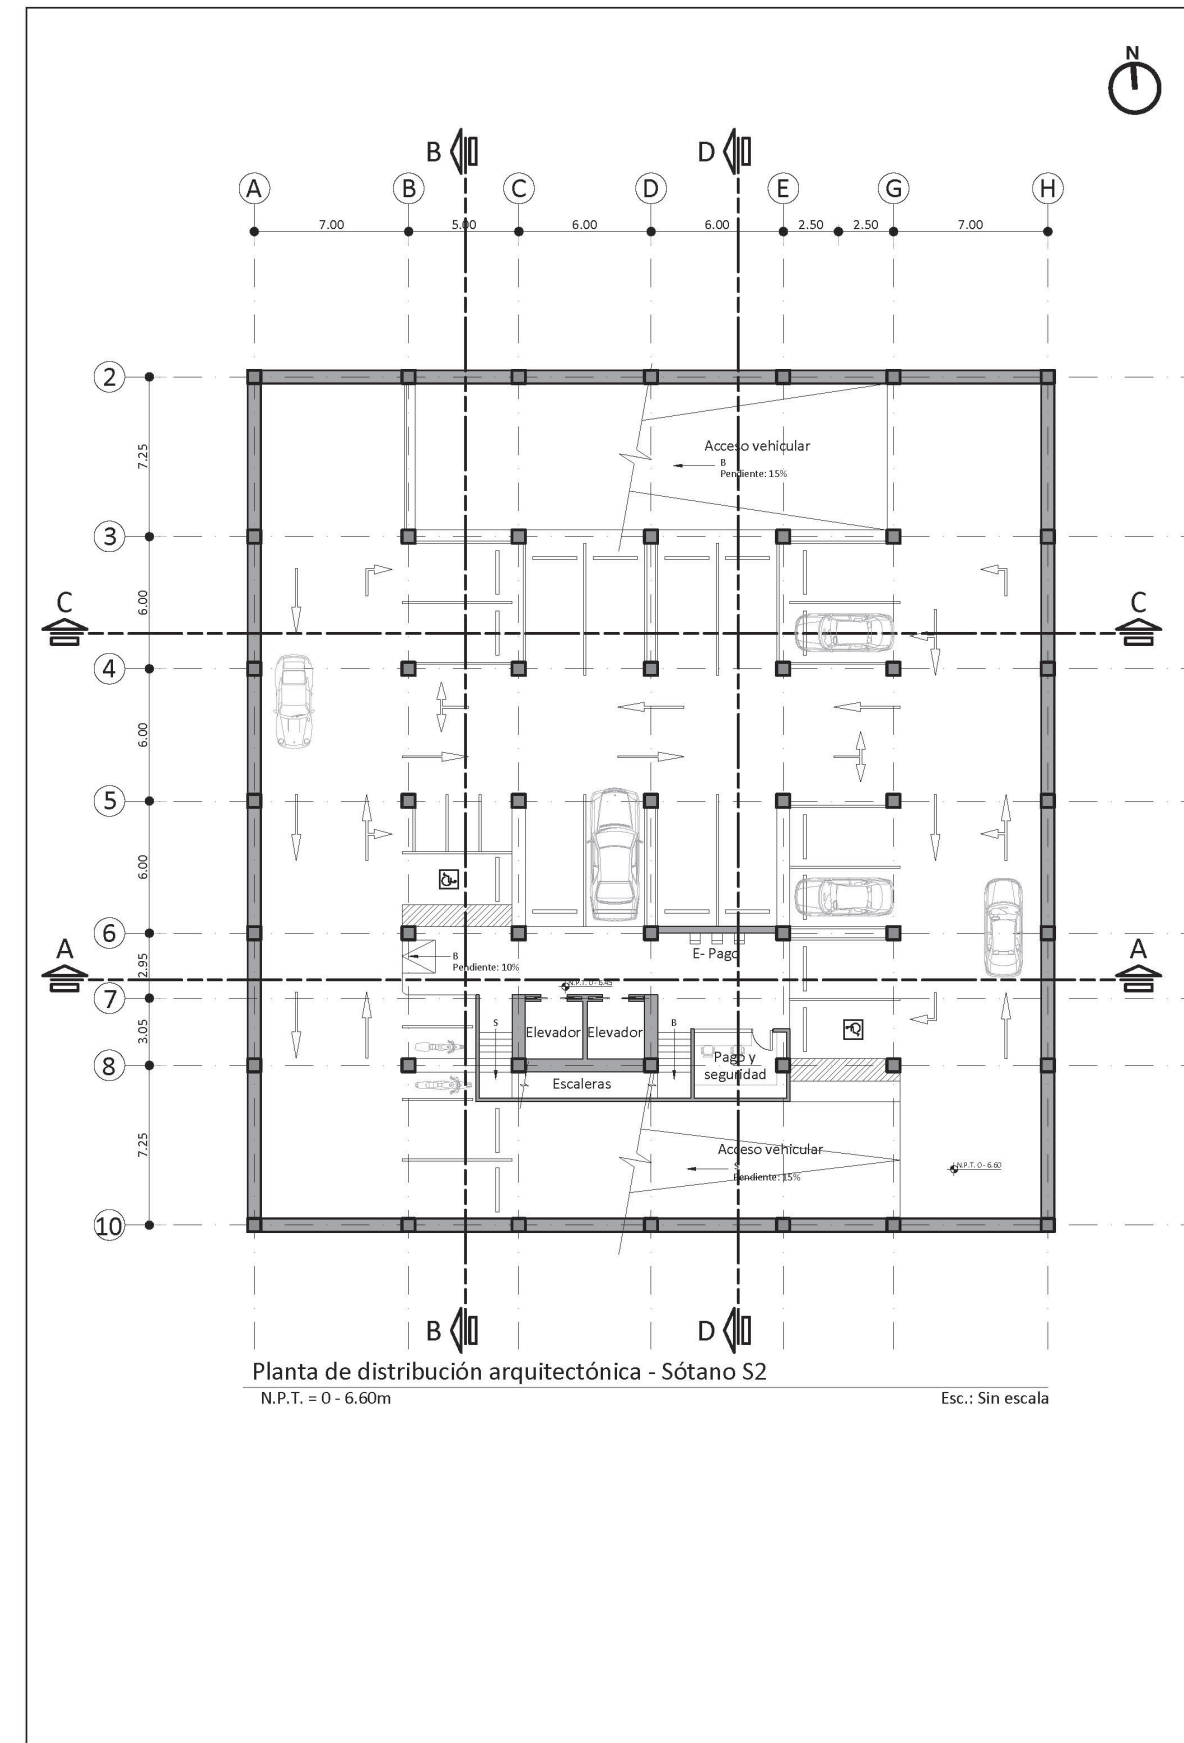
Planta de distribución arquitectónica de sótano 2. Fuente: Propia.
